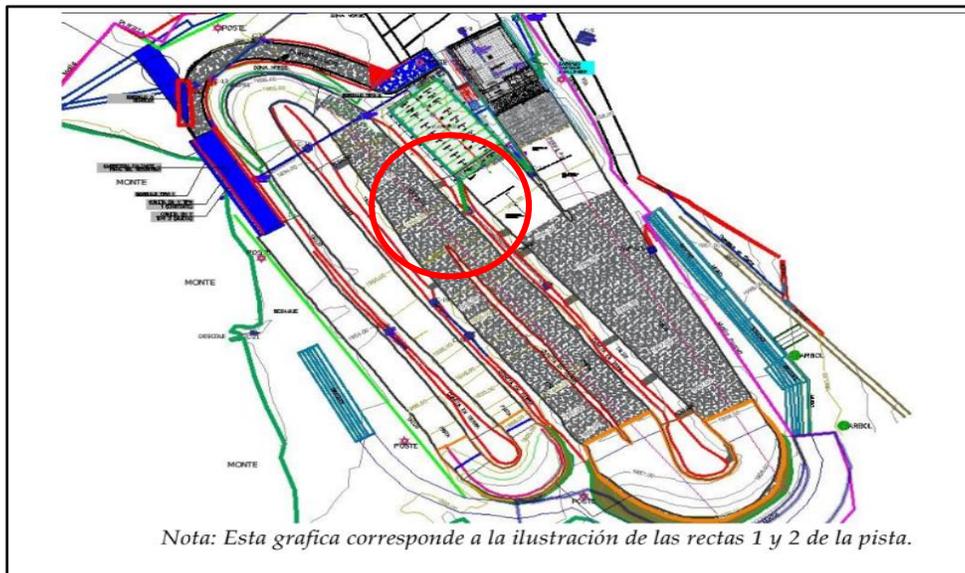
Levantamiento Topográfico final de la pista con intervención
